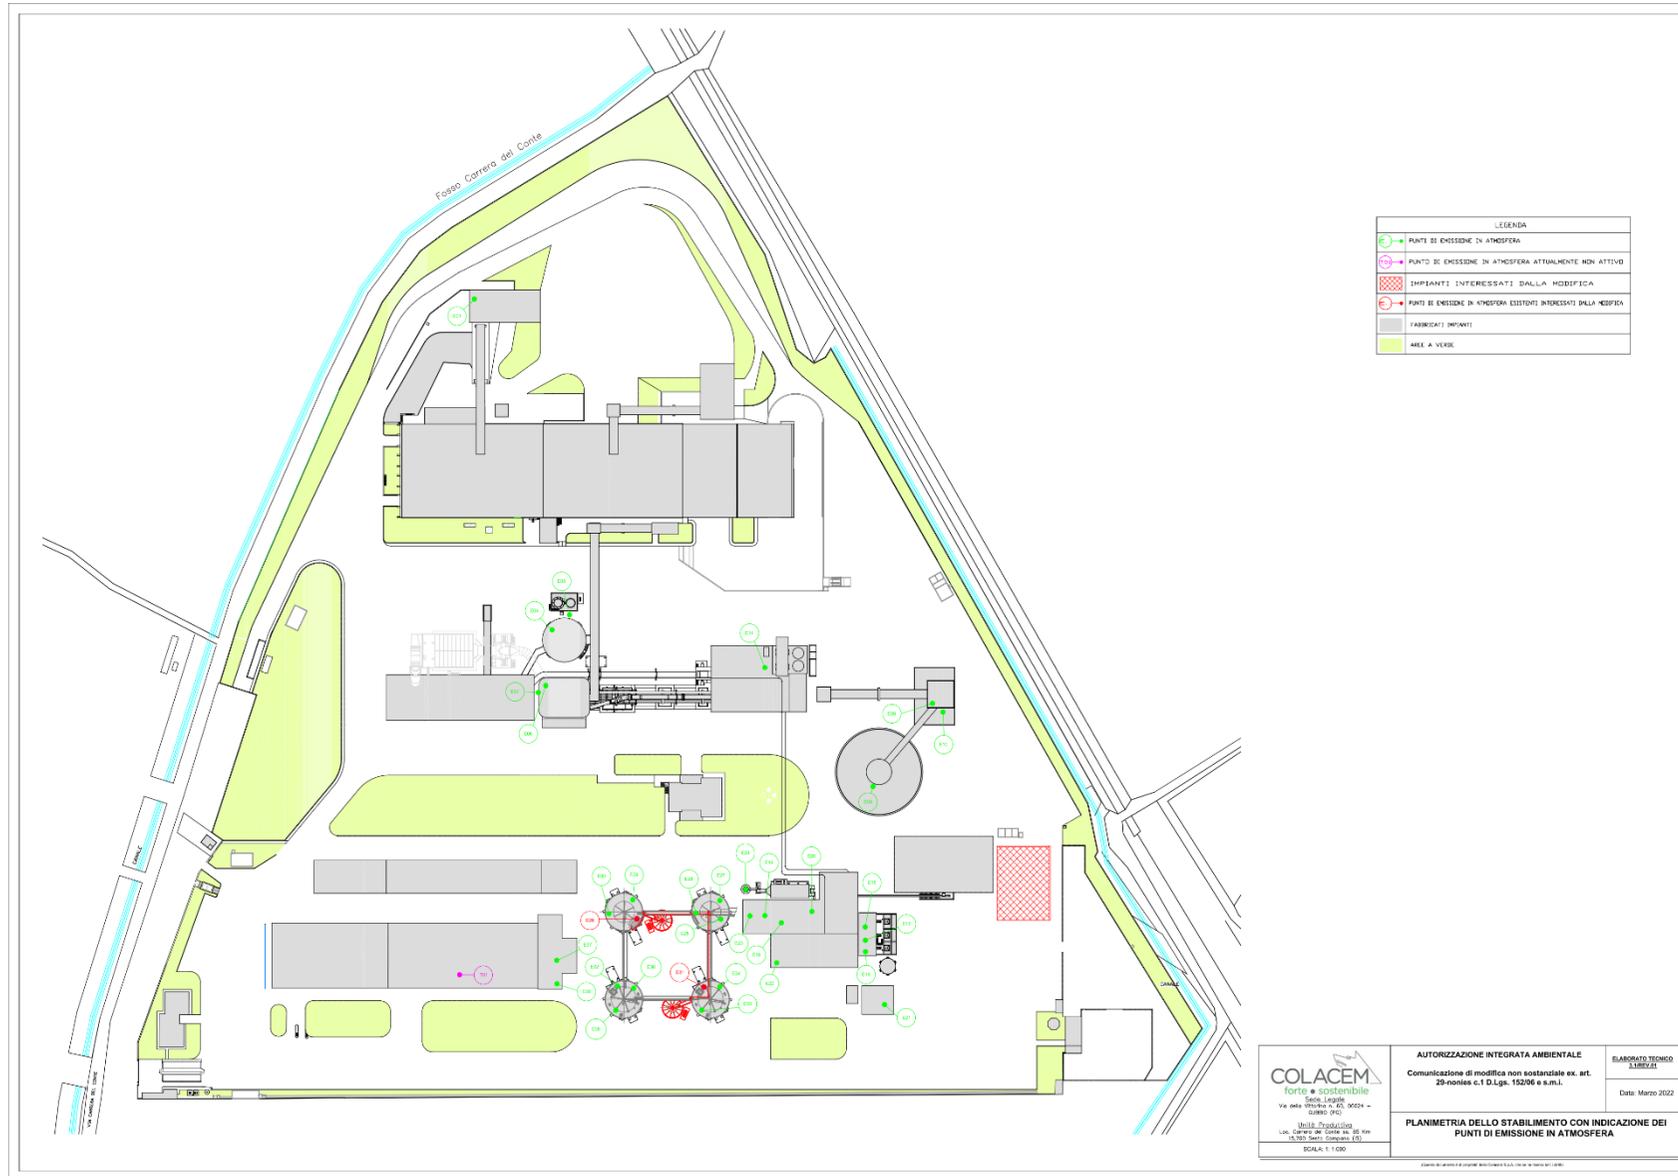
planimetria generale dell'installazione con indicazioni dei punti di emissione in atmosfera: assetto "post operam"
